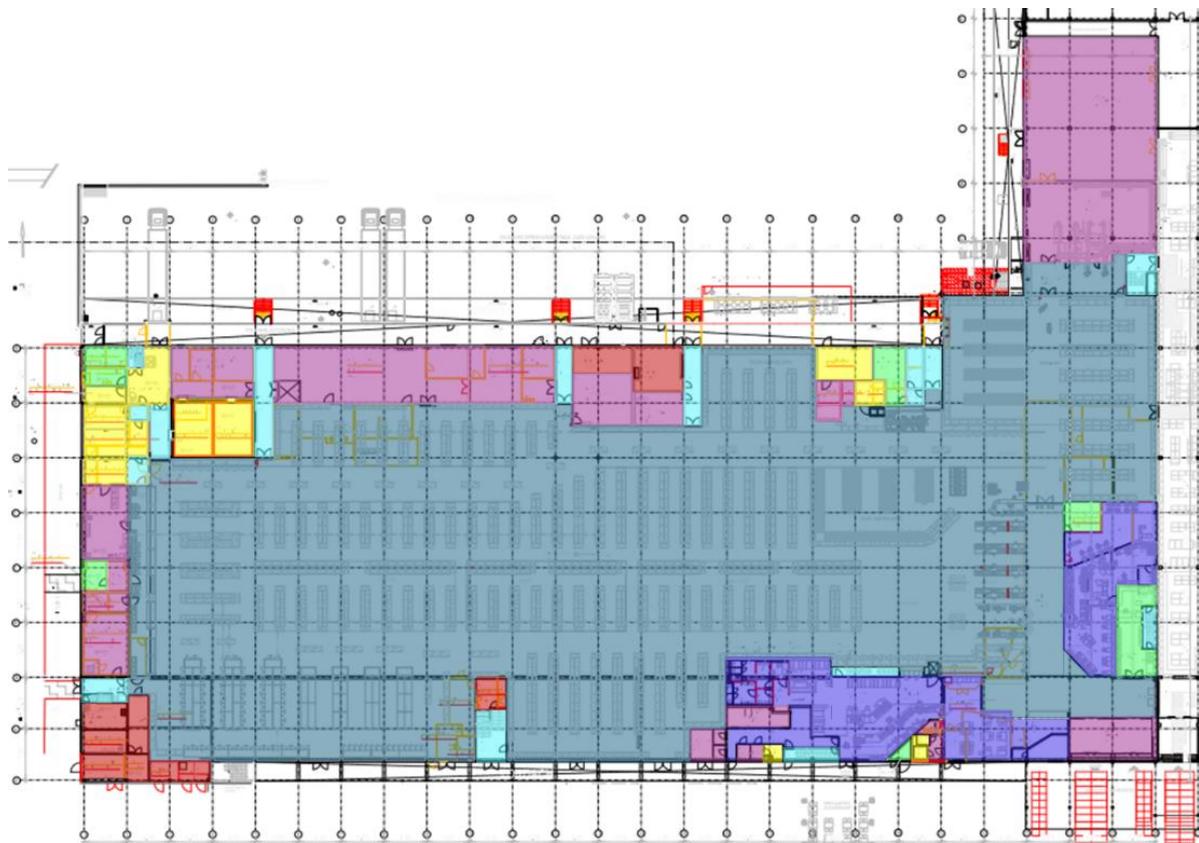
Grundriss Erdgeschoss, Temperaturbereiche [2] bearbeitet
